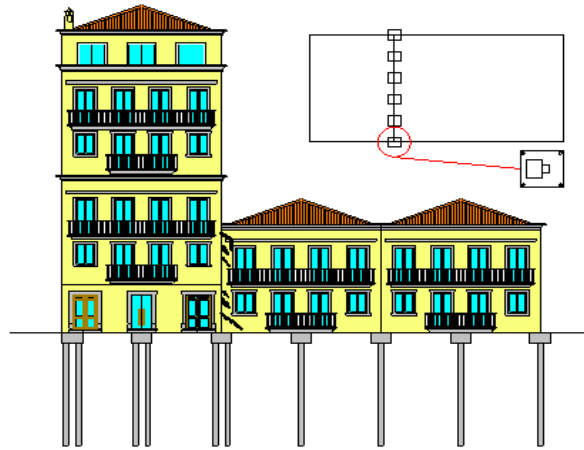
Assentamentos e fissuras provocadas por carregamentos diferentes na mesma fundação sem junta de separação (Modificado, Schnaid et al., 2005).
